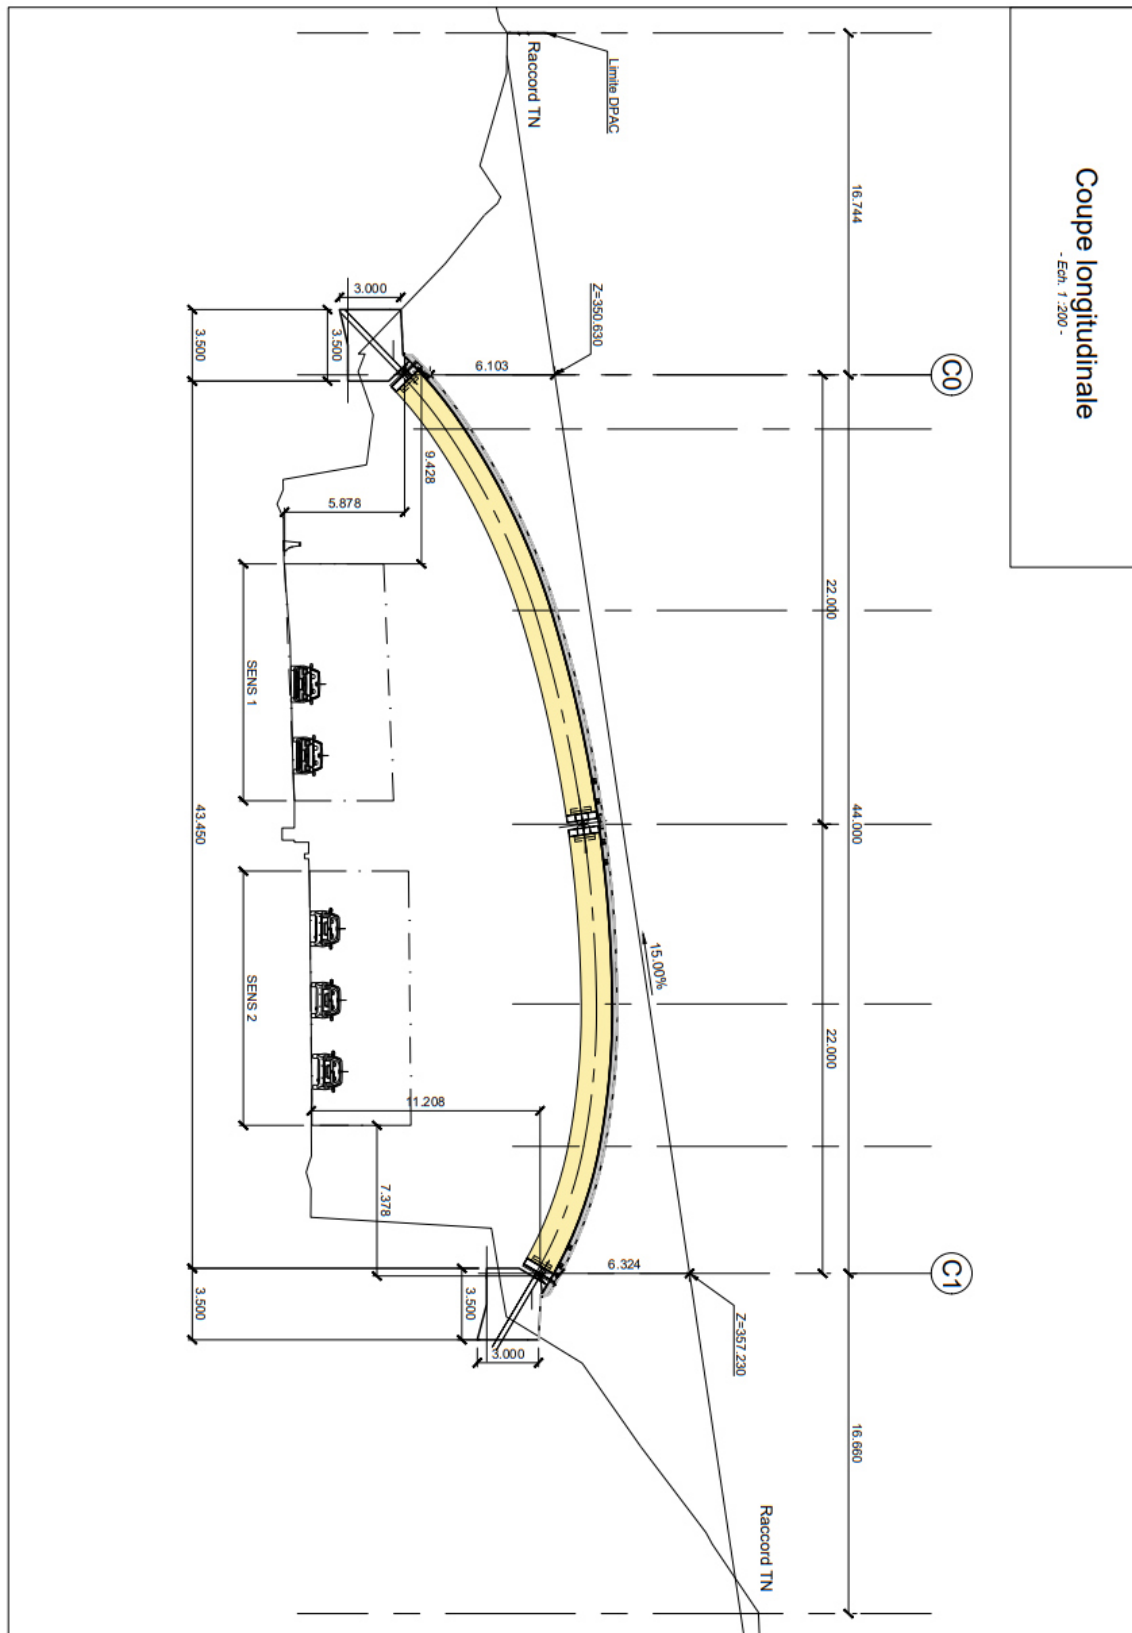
Plan des travaux - Vue de face, côté Strasbourg (04/09/2025)
